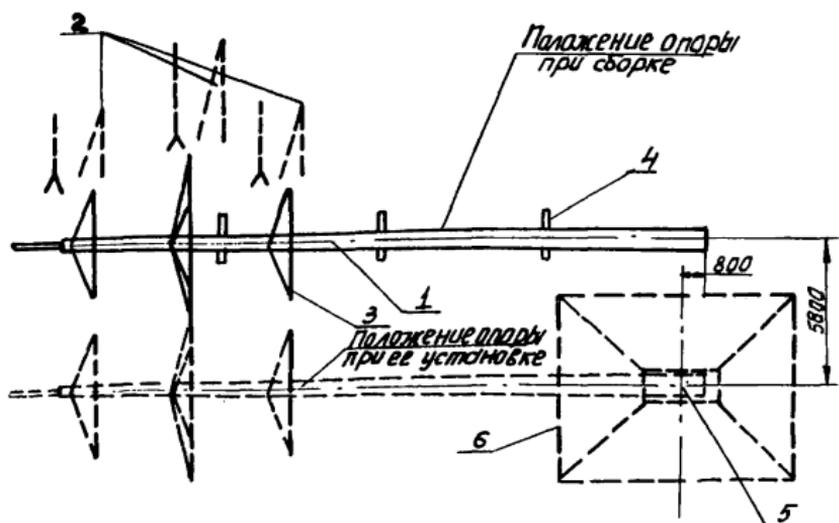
Схема выкладки и сборки опор при копаных котлованах
